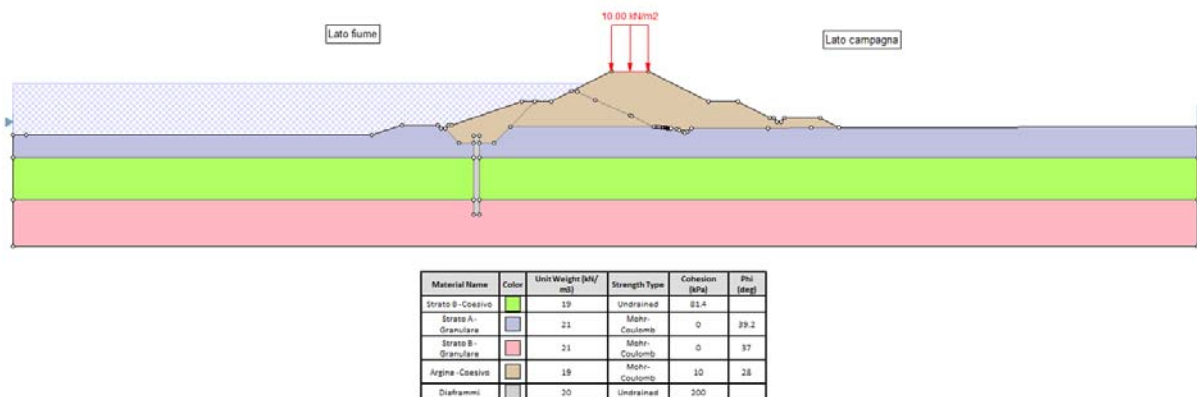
Sezione Tipo D2 – Sez. P1.58
